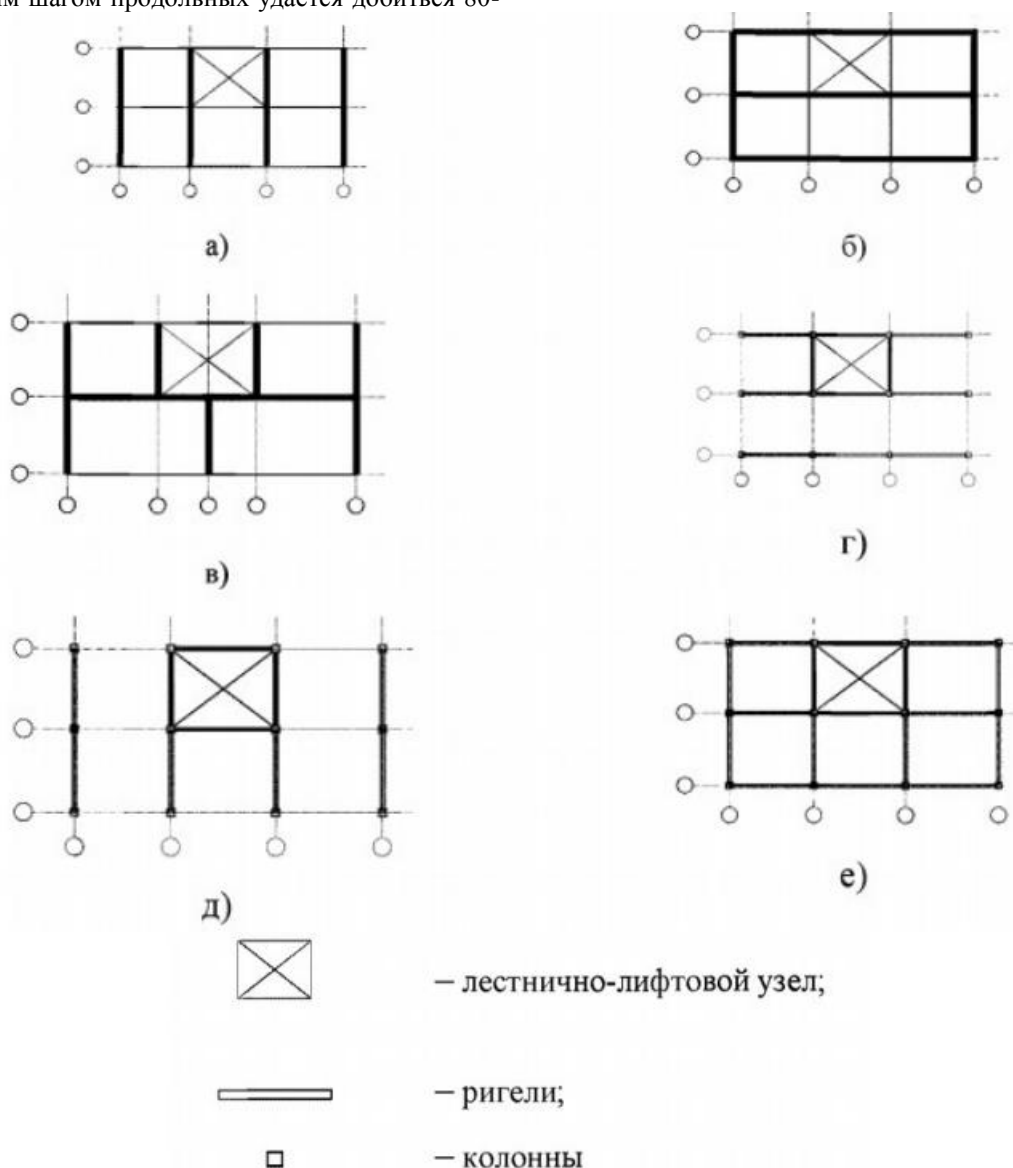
Схемы конструктивных решений многоэтажных жилых домов с широким шагом: а) поперечно-стеновая; б) продольно-стеновая; в) перекрестно-стеновая; г) каркасное устройство с продольным расположением ригелей; д) каркасное устройство с поперечным расположением ригелей; е) каркасное устройство со смешанным расположением ригелей
